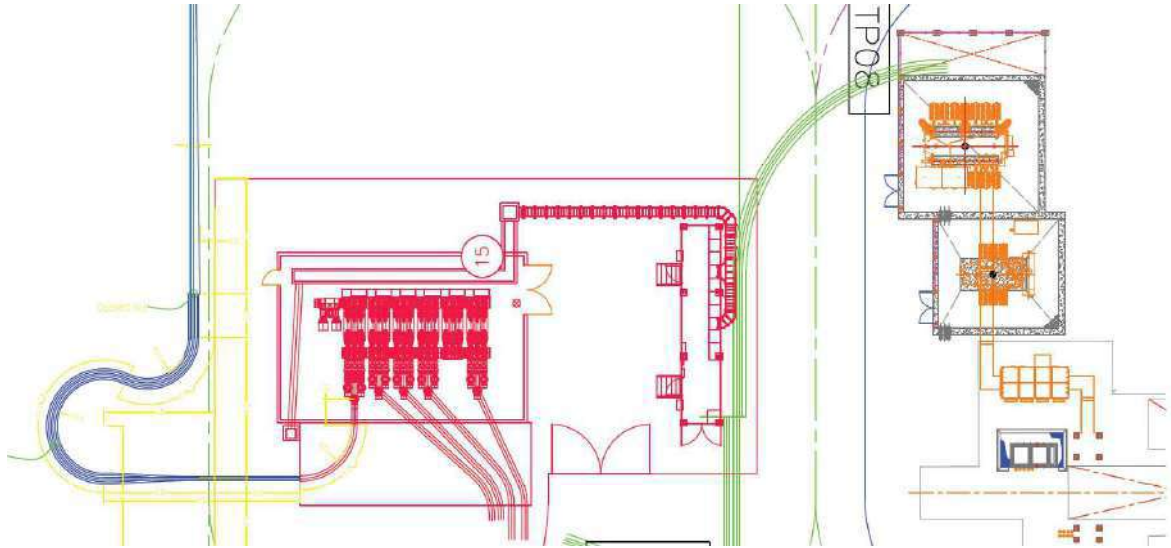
Disposición de los cables 220 kV, triple terna.
